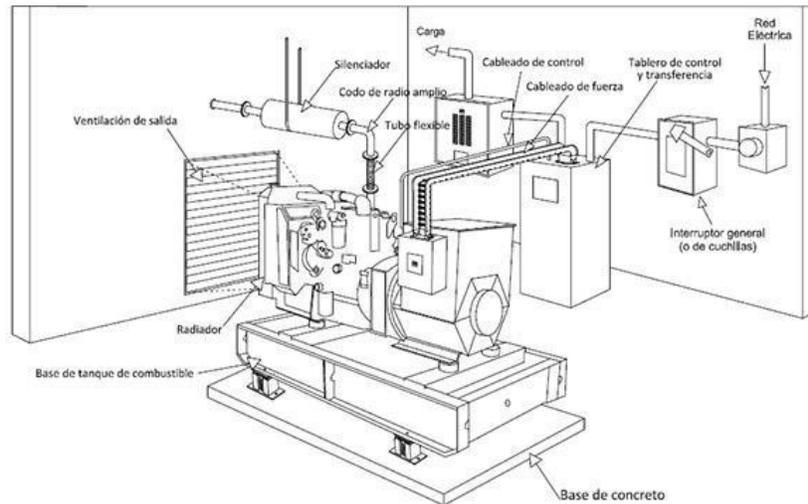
Instalación convencional de una planta eléctrica. Fuente Manual instalación plantas eléctricas de emergencia.
